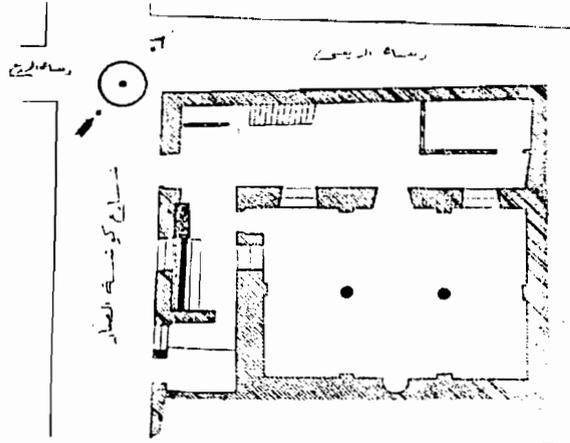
مسقط أفقي لجامع درغوت باشا عن الموسوعة (الجزء الأول).
